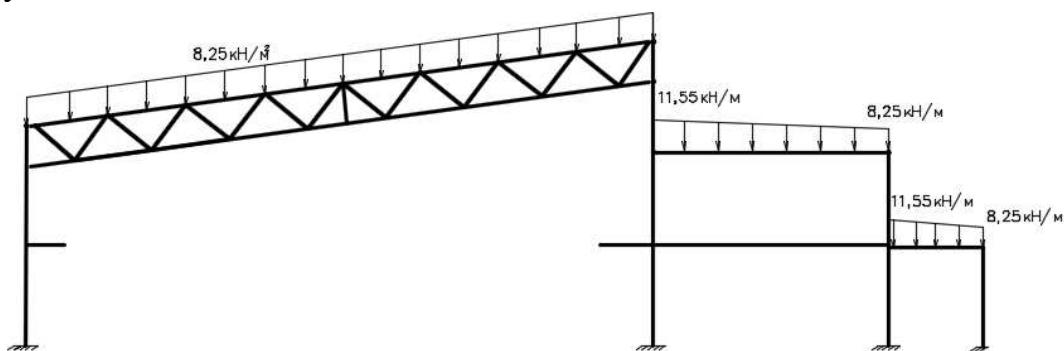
Расчетная схема для определения усилий от снеговой нагрузки
